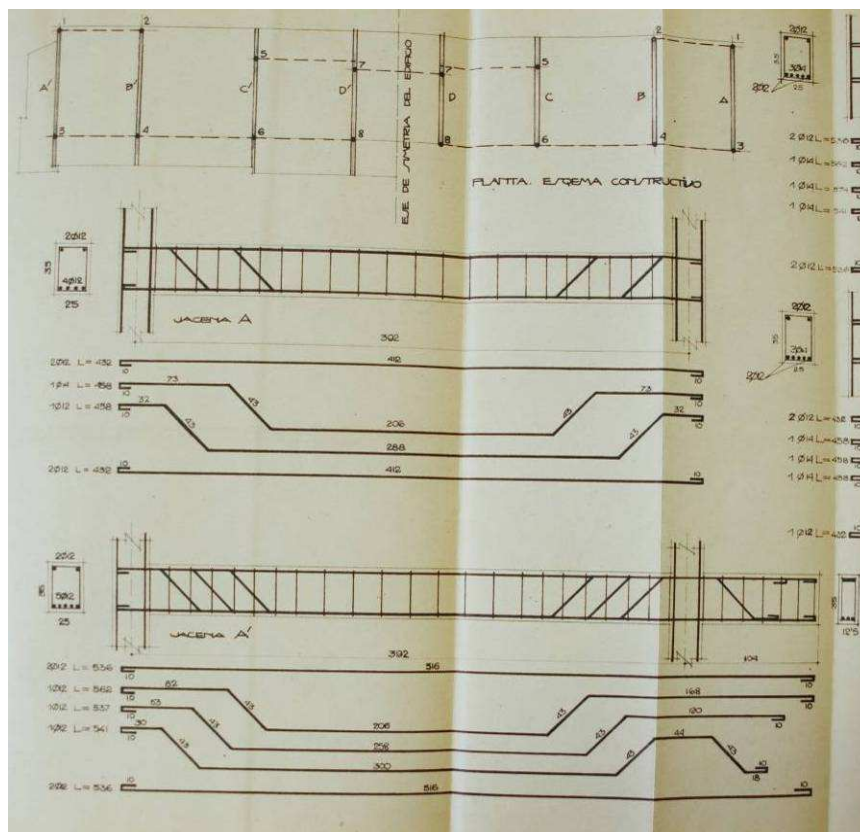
Detalle armadura Edificio ficha 143C.006, 1959.
